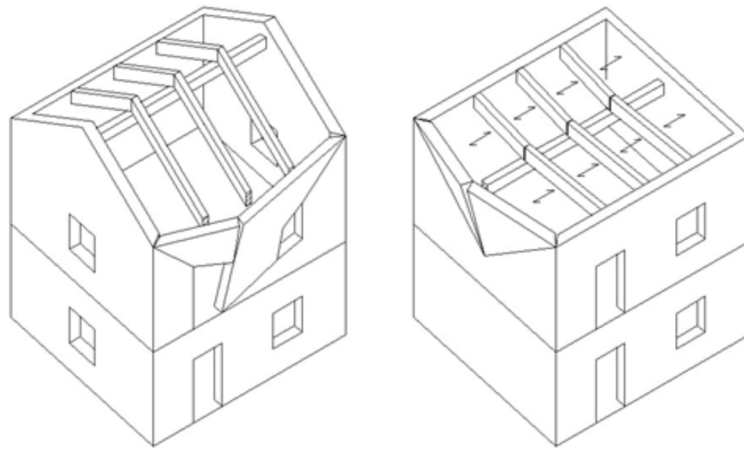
Possibili meccanismi di flessione orizzontale (a sinistra sfondamento della parete perimetrale, a destra sfondamento del timpano)
